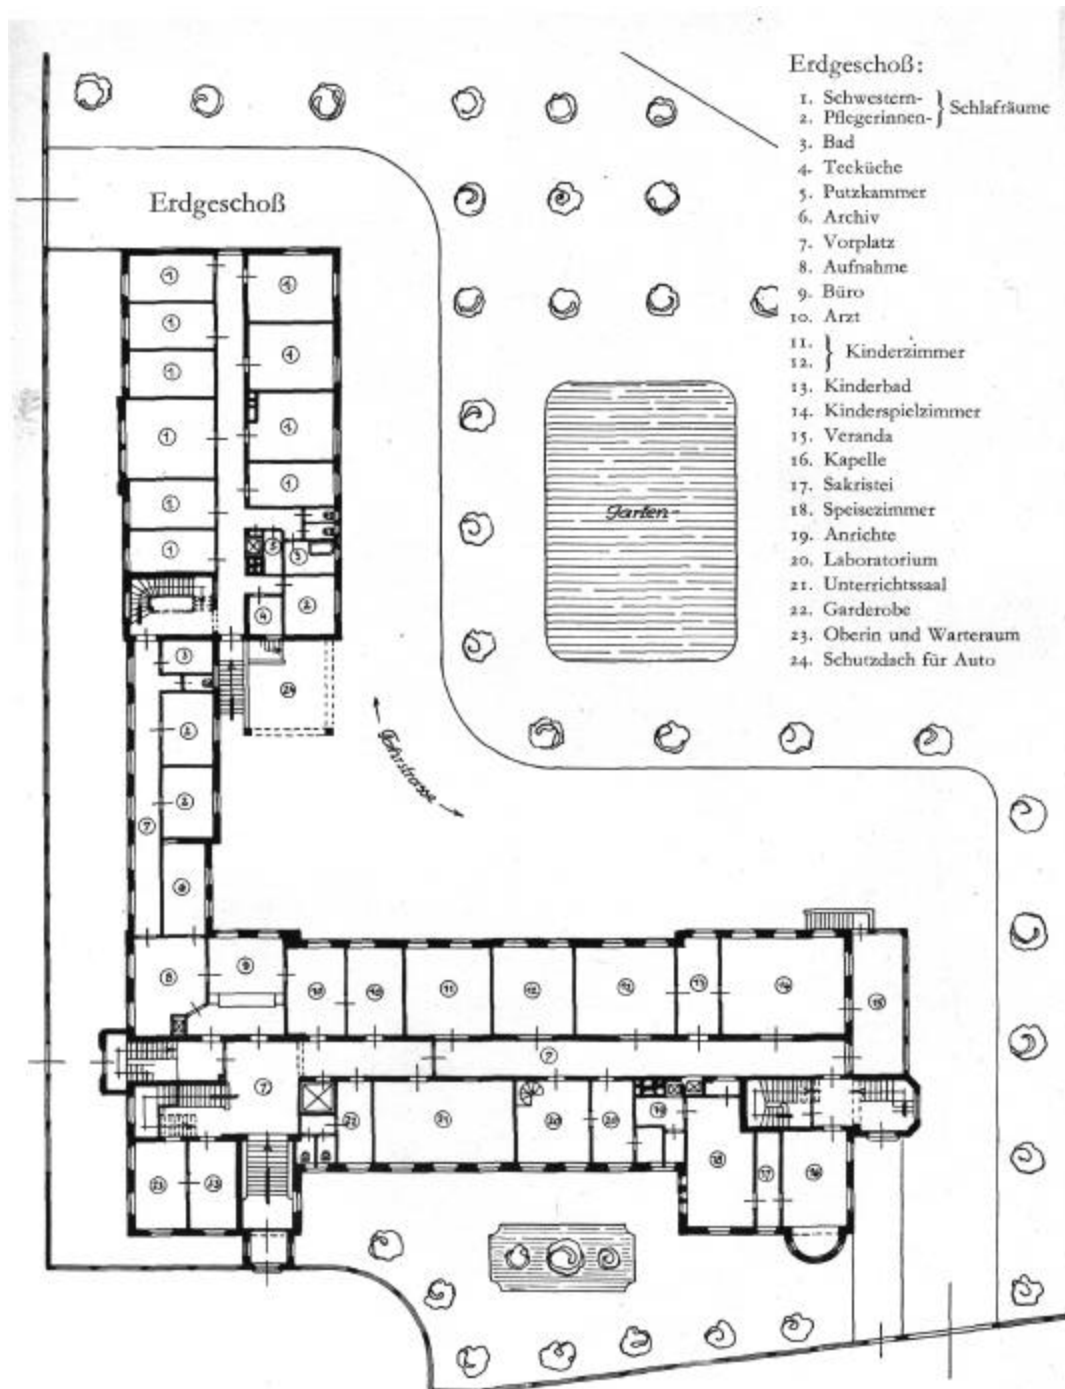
Grundriss Erdgeschoß (16,S.25) mit Erweiterungsbau aus dem Jahre 1913
